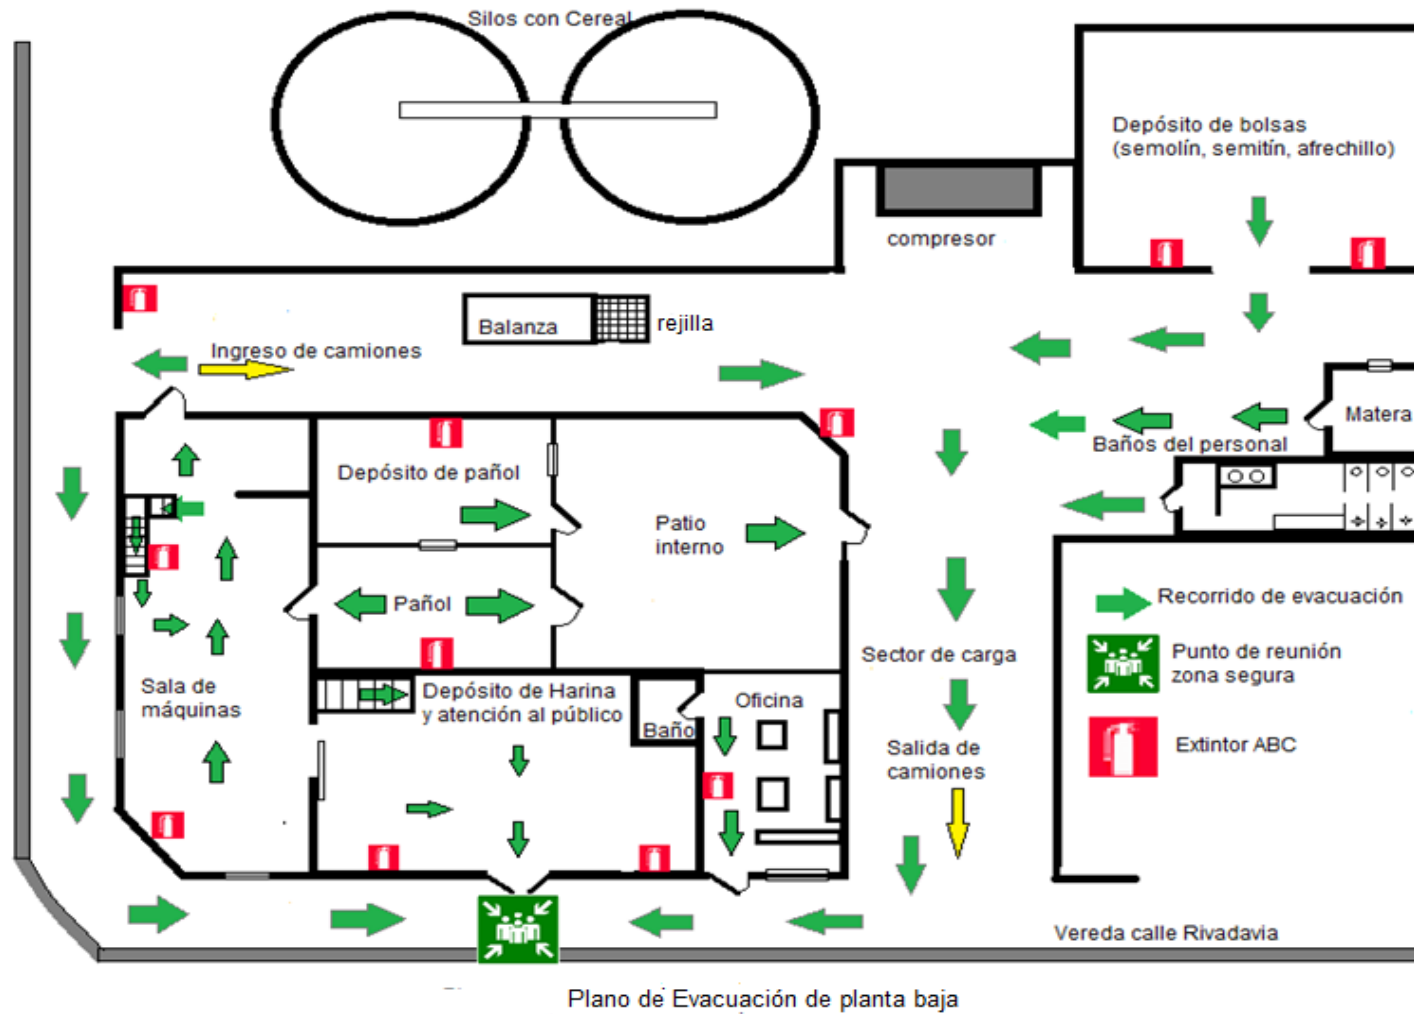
Plano/Croquis Evacuación Planta Baja Molino Harinero
